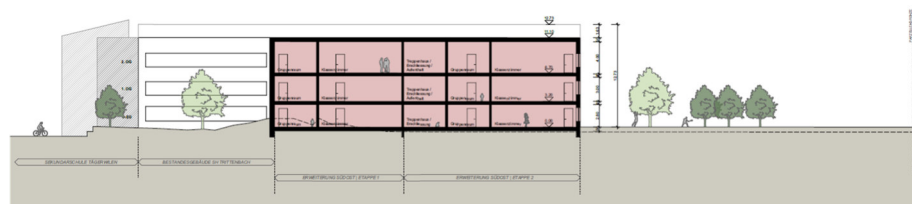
Disposition 02 | Gebäudeschnitt A-A
